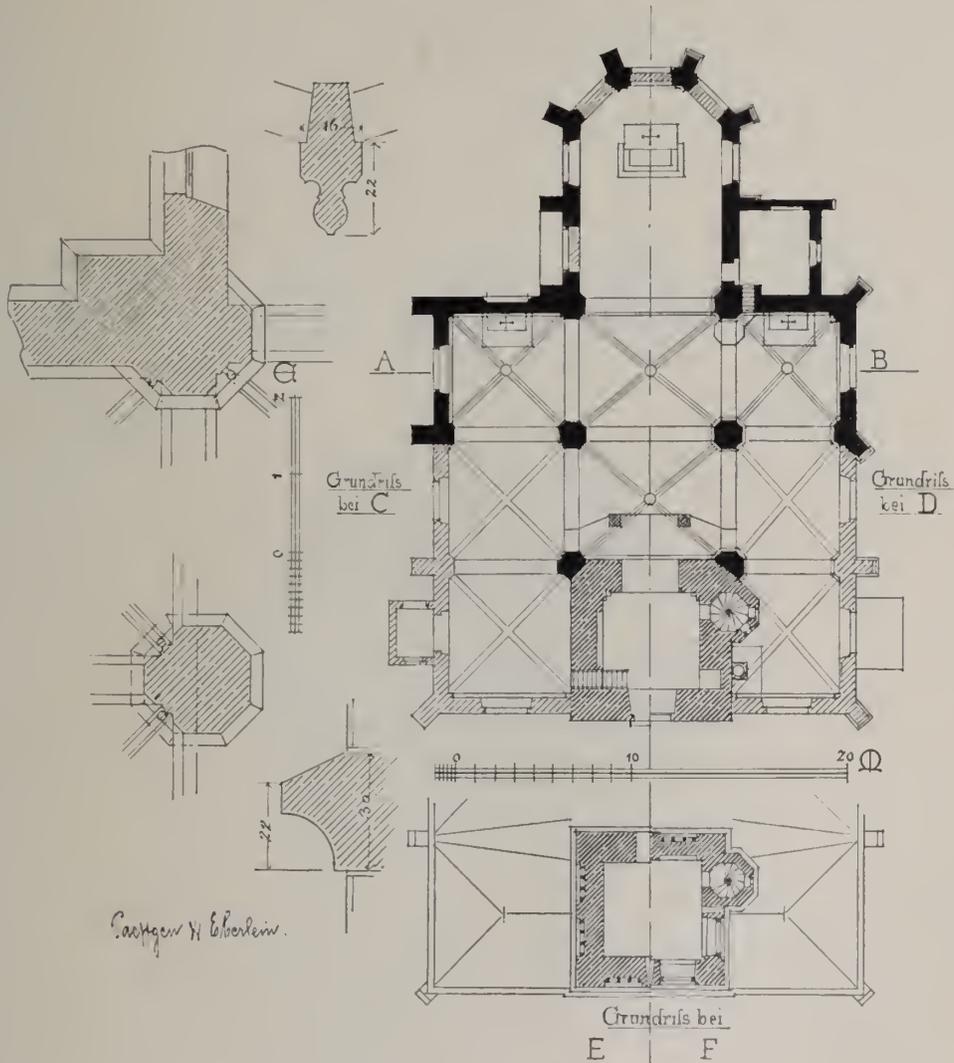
Lobberich. Pfarrkirche. Grundriss und Details.
